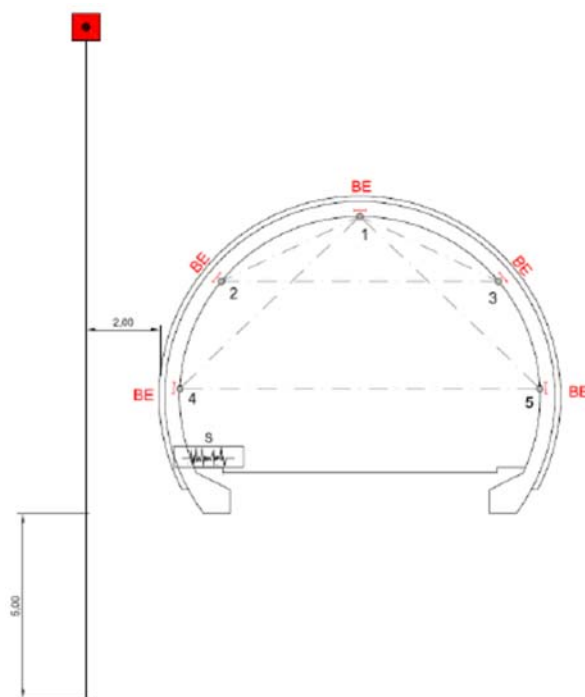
Secção tipo H de instrumentação no túnel norte existente
